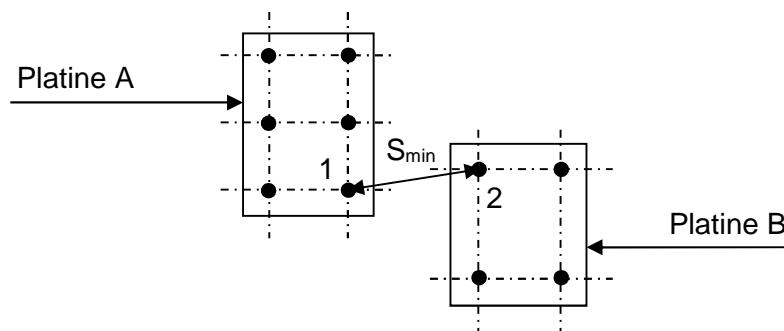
Distance minimale entre chevilles de dispositifs d'ancrage mitoyens.
